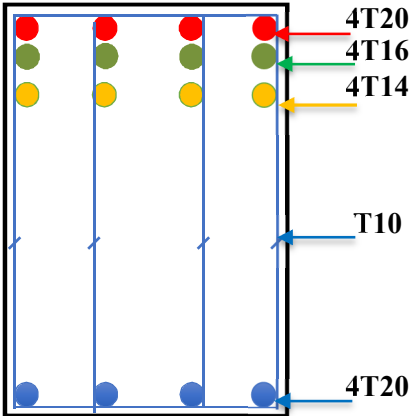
Ferrailage de la poutre de libage (sens transversal)
